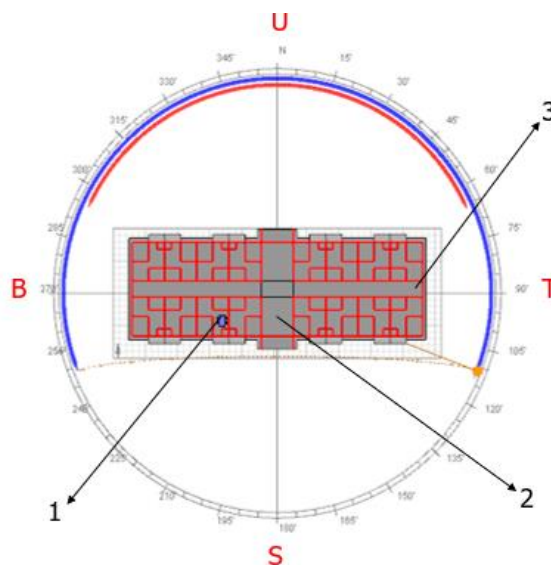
Denah Bangunan (Analisa Pribadi)
